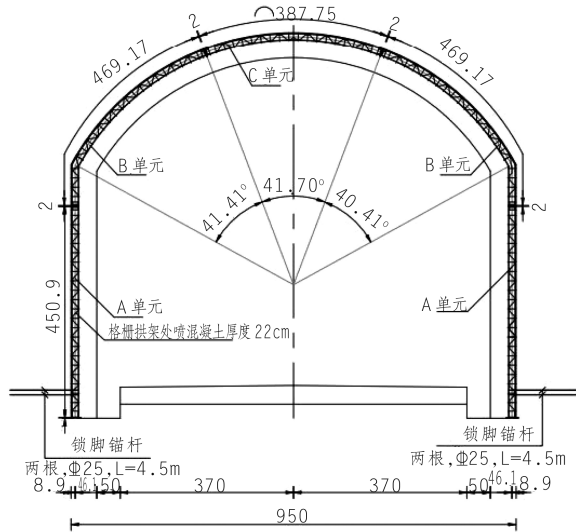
引水 2~4 号施工支洞Ⅳ类围岩钢筋格栅拱架安装设计图(单位:cm)
